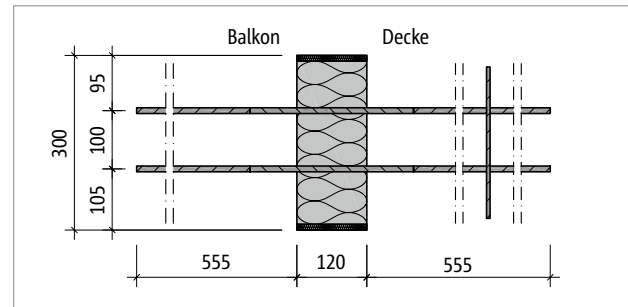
Schöck Isokorb® XT Typ QP-Z-V1: Produktgrundriss
